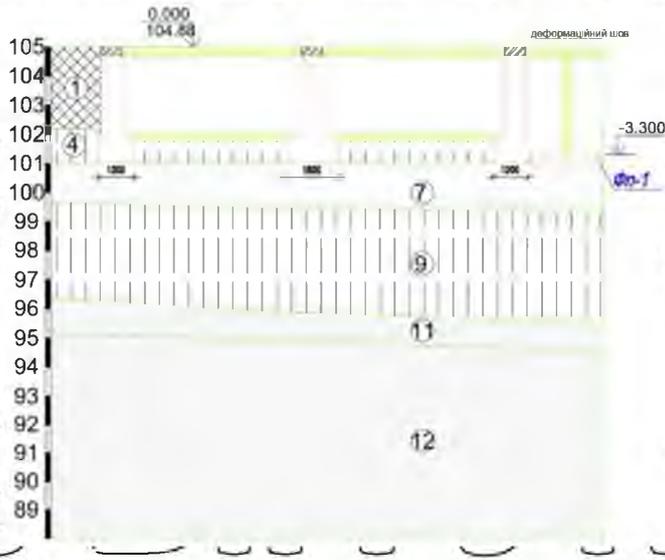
Обмірні креслення стрічкових бутобетонних фундаментів
